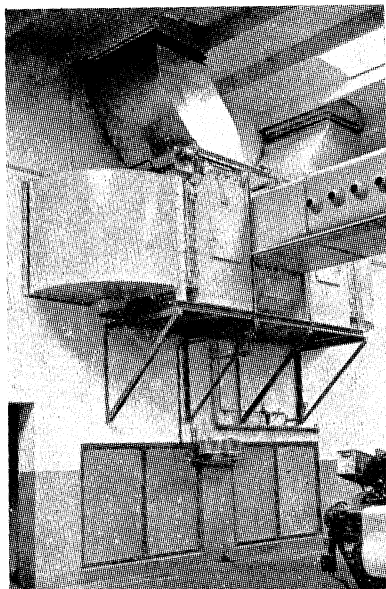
Radiální ventilátor s dýzami — výrobek holandské firmy Bronswerk.
